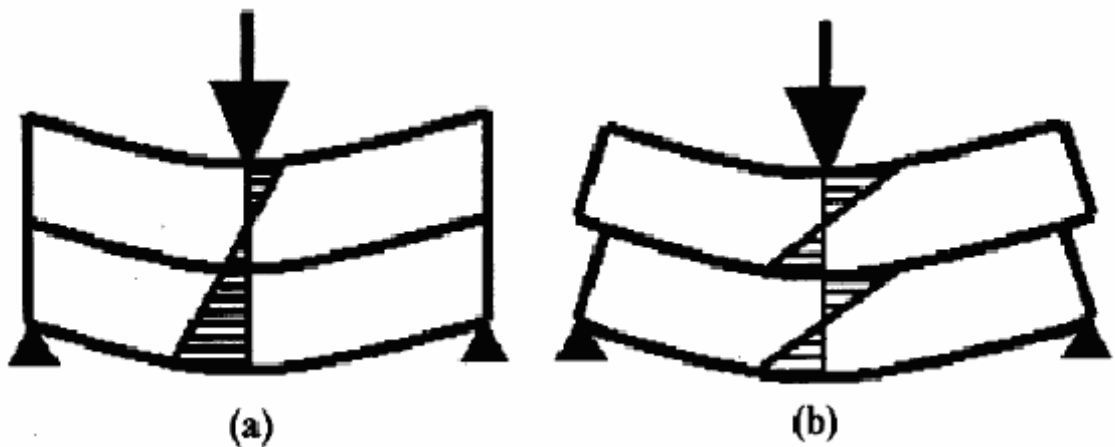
Estado de tensiones estructura de dos capas, a) pavimento monolítico b) pavimento con capas despegadas
